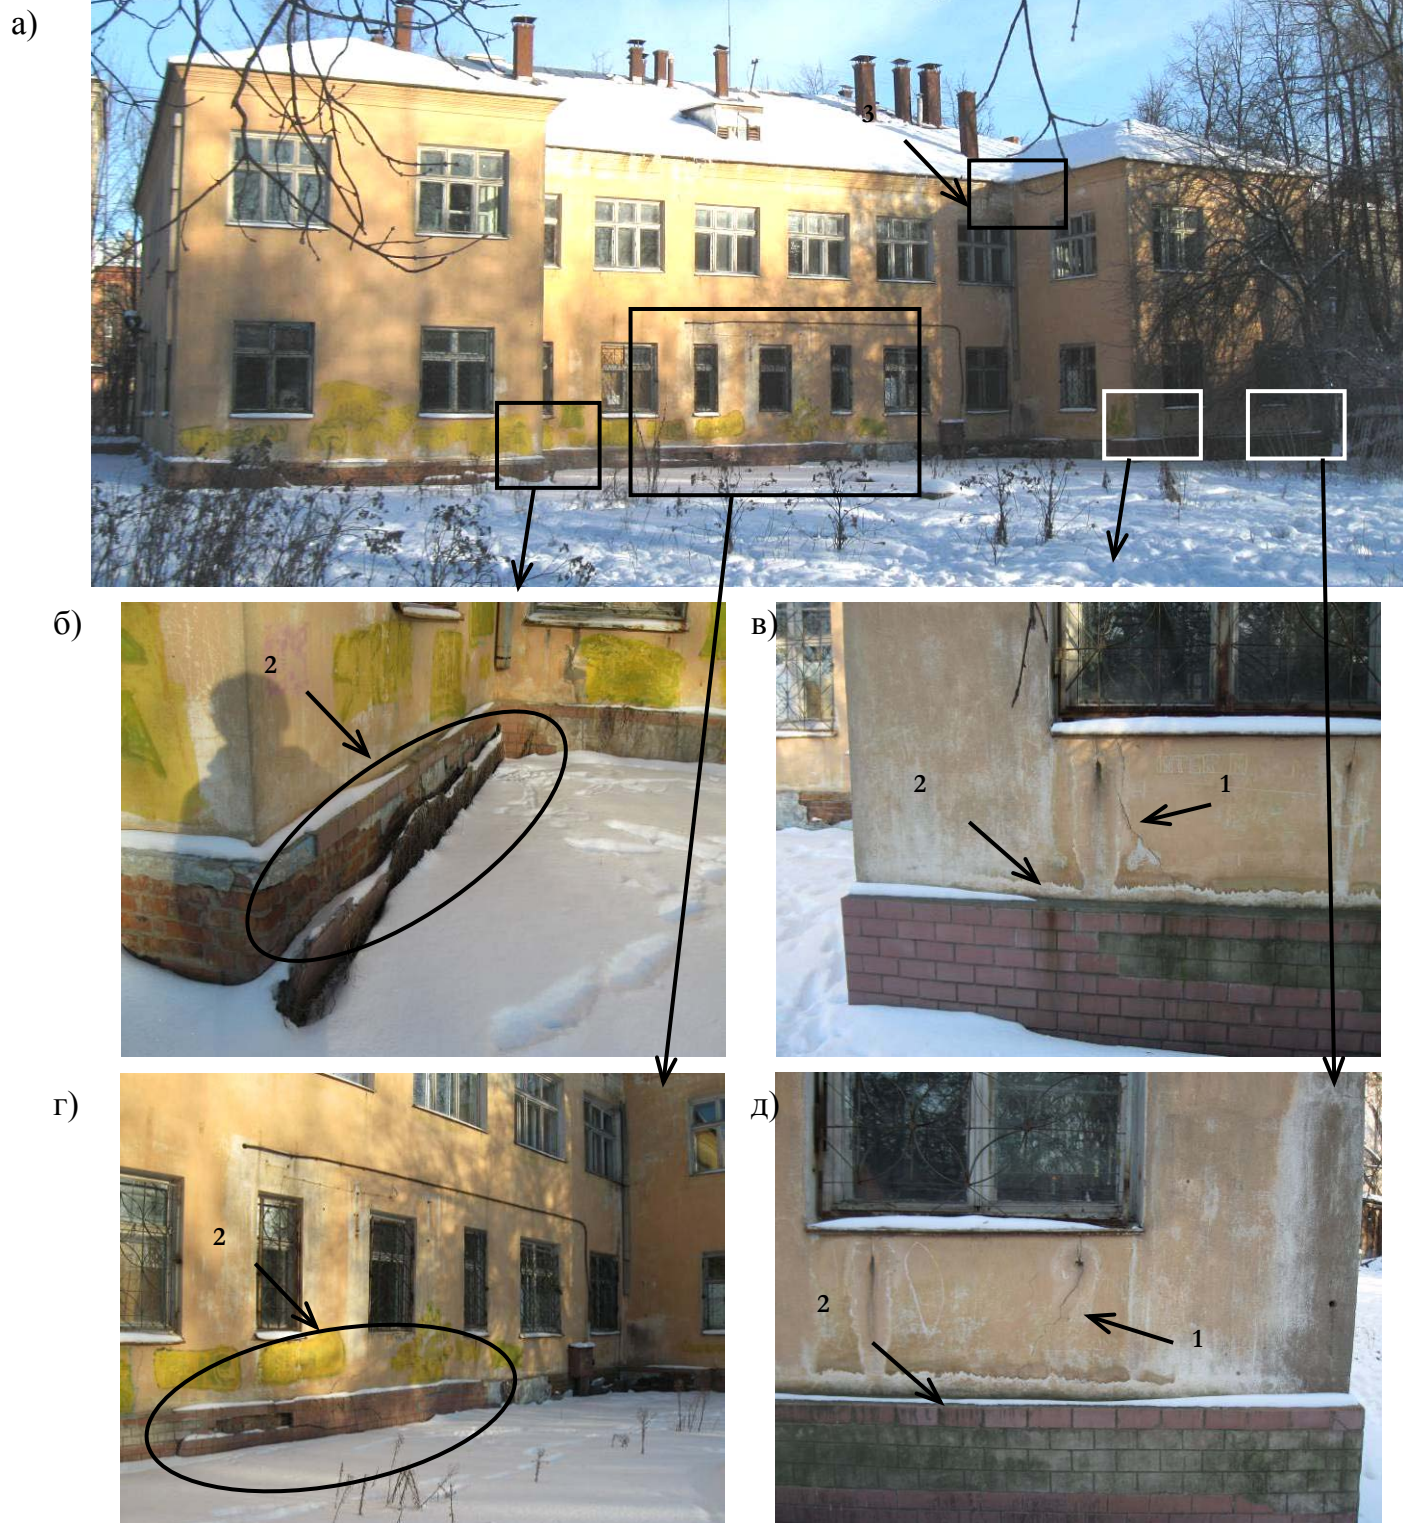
Освидетельствование стен здания по оси Д и Е: 1 – наклонные трещины с шириной раскрытия 0,3...1,0 мм под оконными проемами первого этажа; 2 – увлажнение цоколя и отслоения облицовки; 3 – участки увлажнения карнизной части кладки
